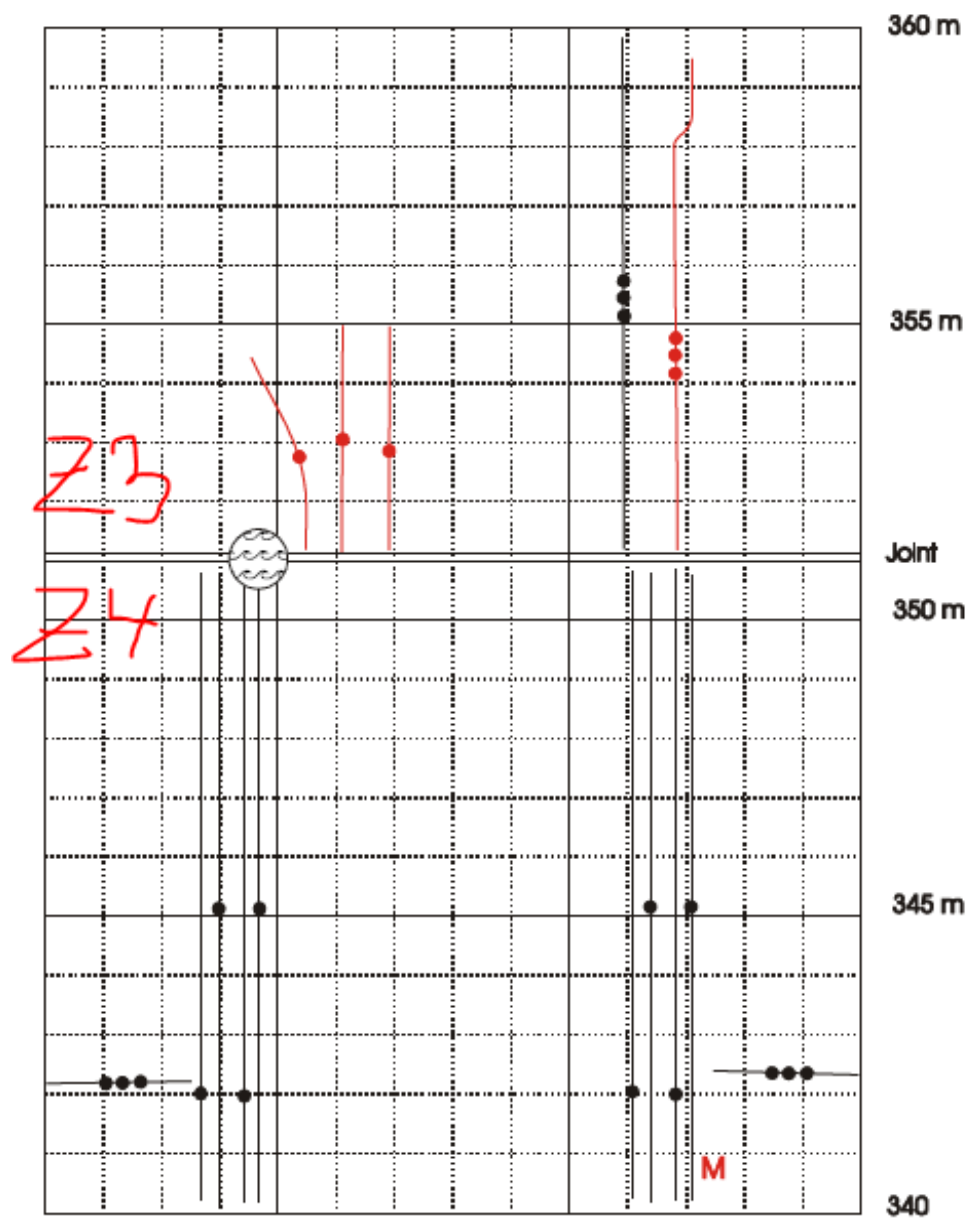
Planche de fissuration travée Sud-Ouest Zone 3
